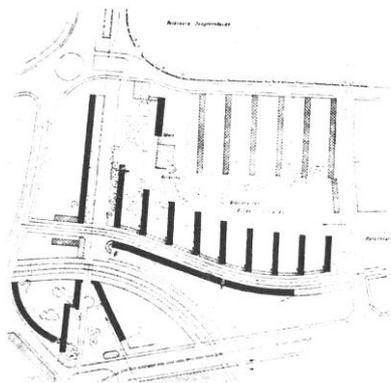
12. Plan de edificación del primer proyecto para la Siemensstadt Siedlung, marzo de 1929
